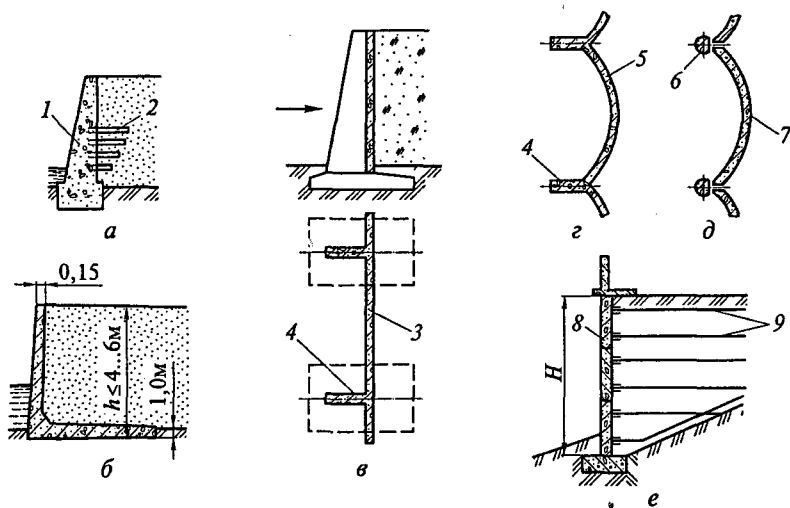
Монолитные и сборно-монолитные подпорные стены набережных:
